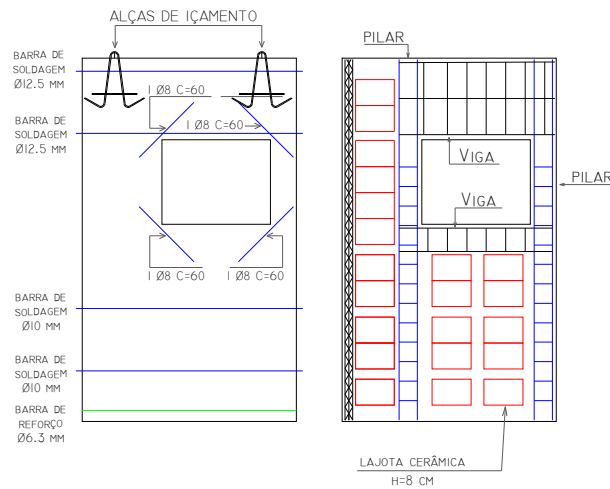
Planta com os elementos constituintes do painel cm vão de janela edificações habitacionais de até 05 pavimentos
